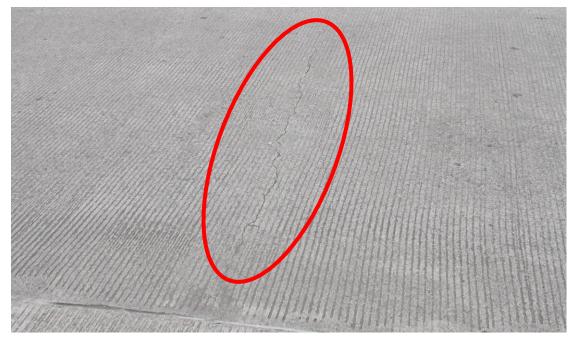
Grieta en la losa interna, estacionamiento 0+494, sentido Zapote – San Francisco
